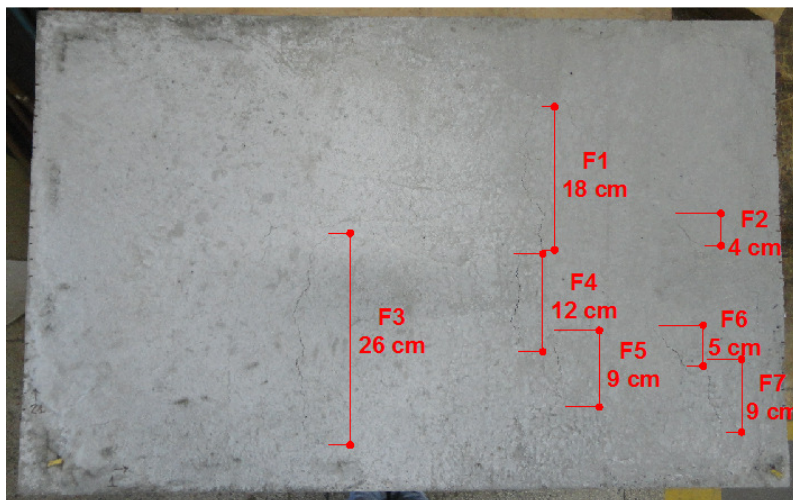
Placa de concreto fissurada por retração plástica com destaque para os comprimentos visíveis das fissuras
